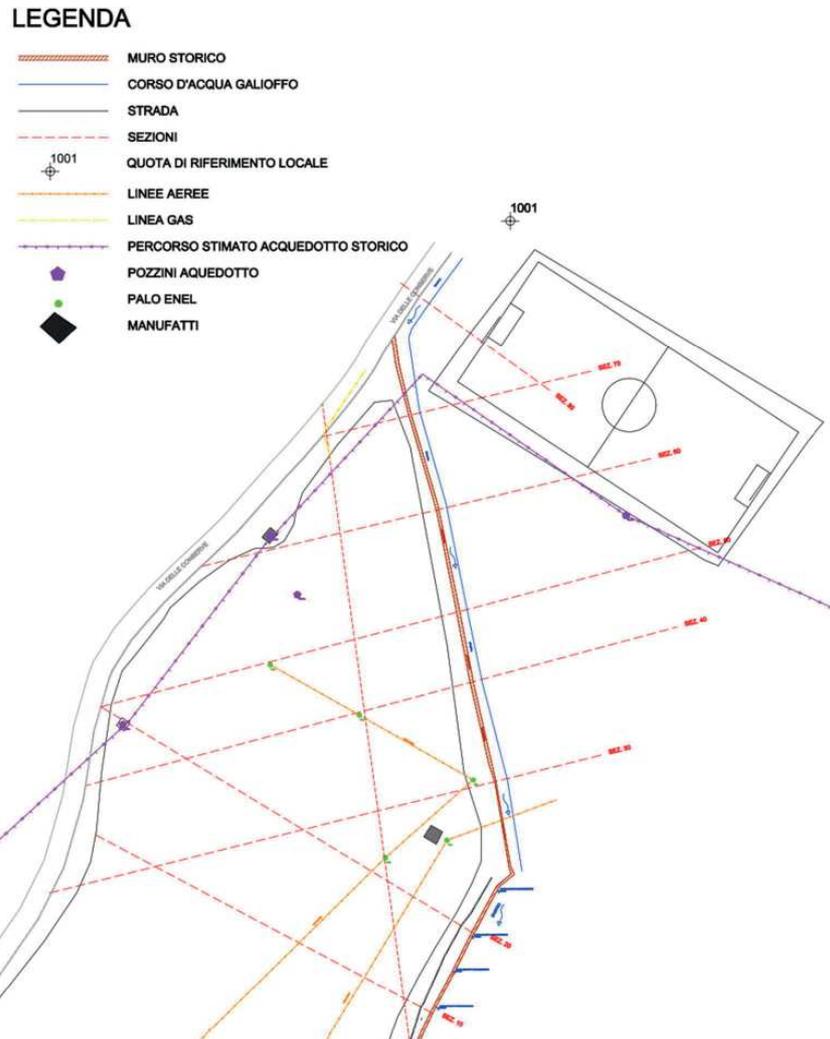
Planimetria Stato Attuale - Corografia sezioni
